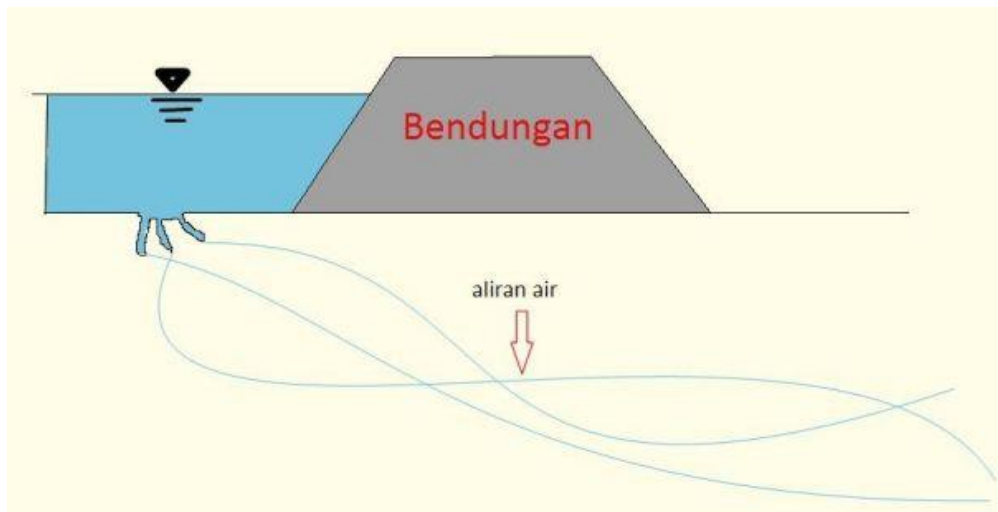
Ilustrasi Pekerjaan Grouting
